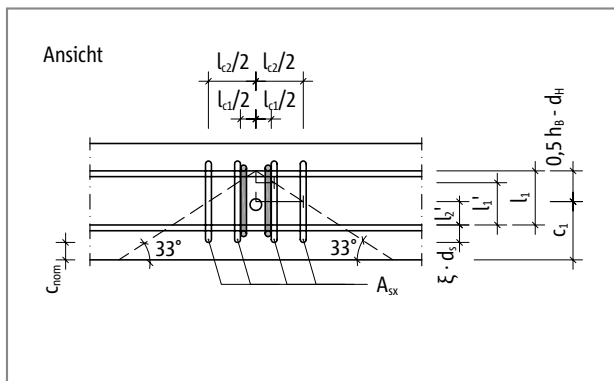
Schöck Dorn Typ SLD: Abmessungen des Ausbruchkegels der Betonkante
